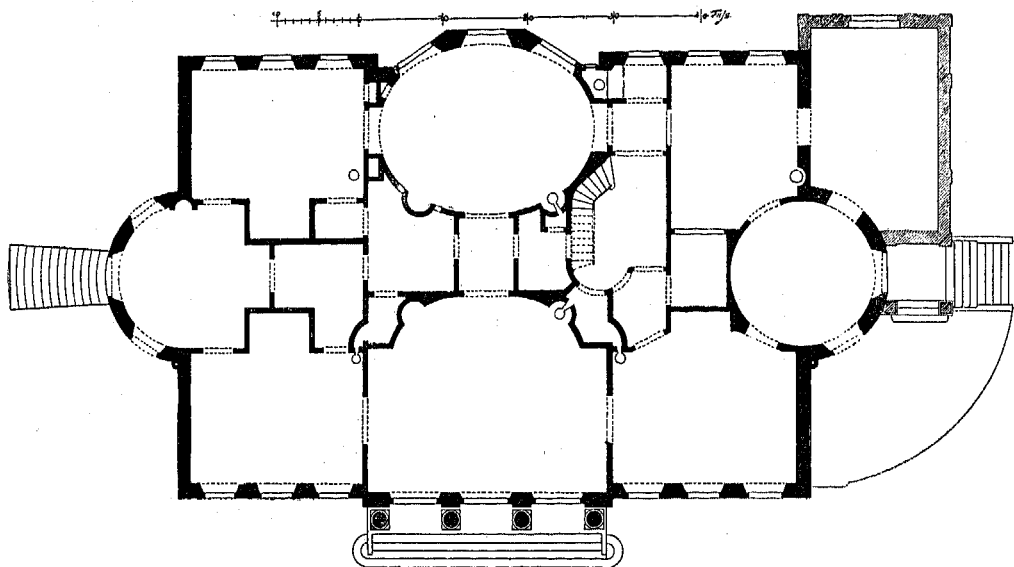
v. Erlangersches Gartenhaus; Grundriss.
